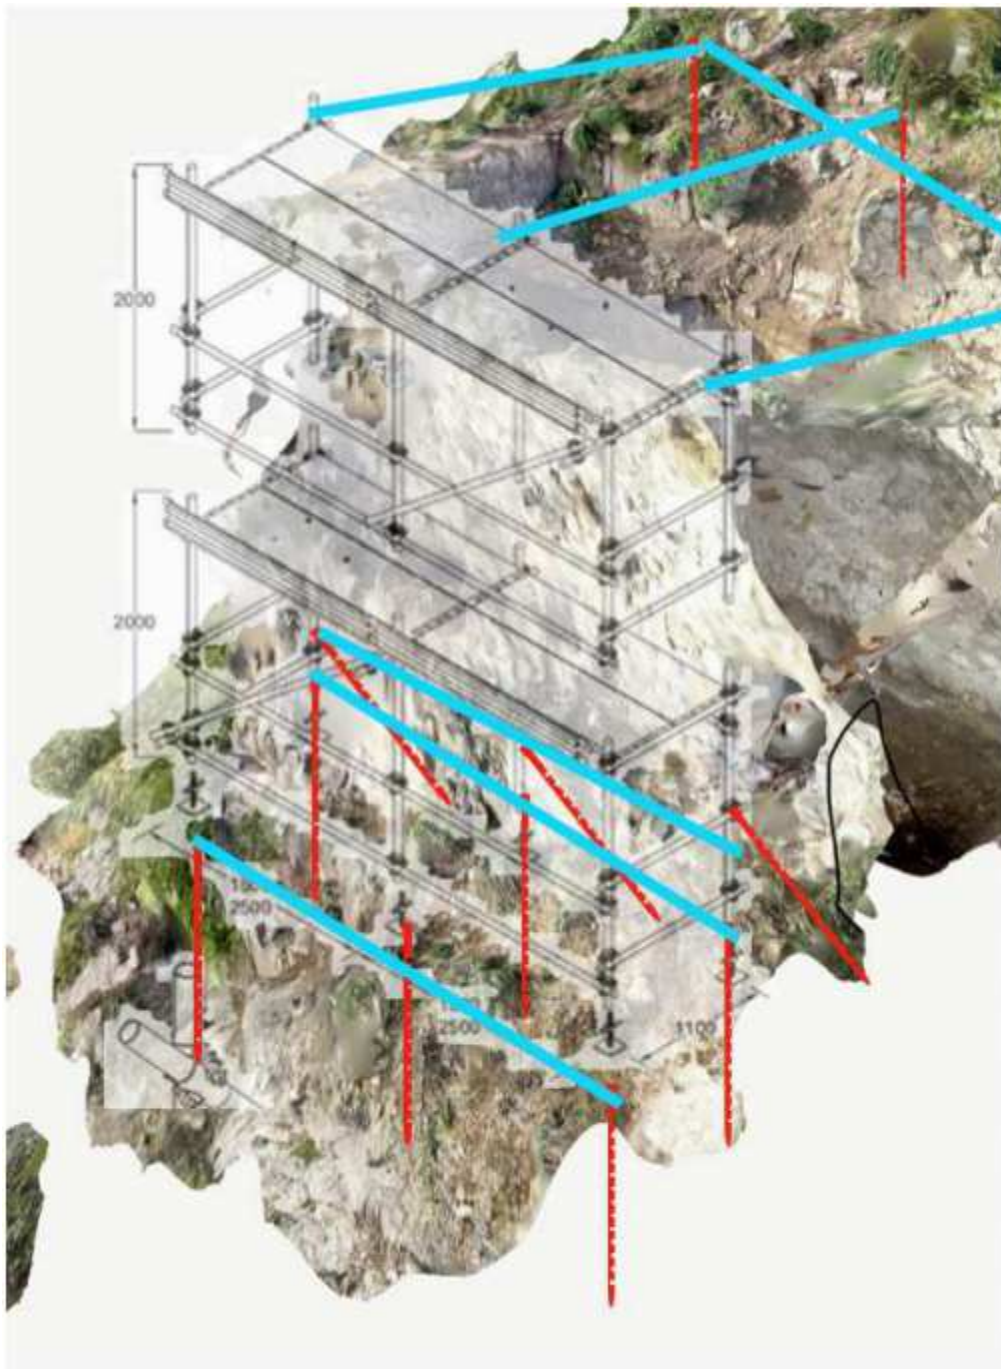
Rendering del ponteggio previsto lungo una sezione tipo
